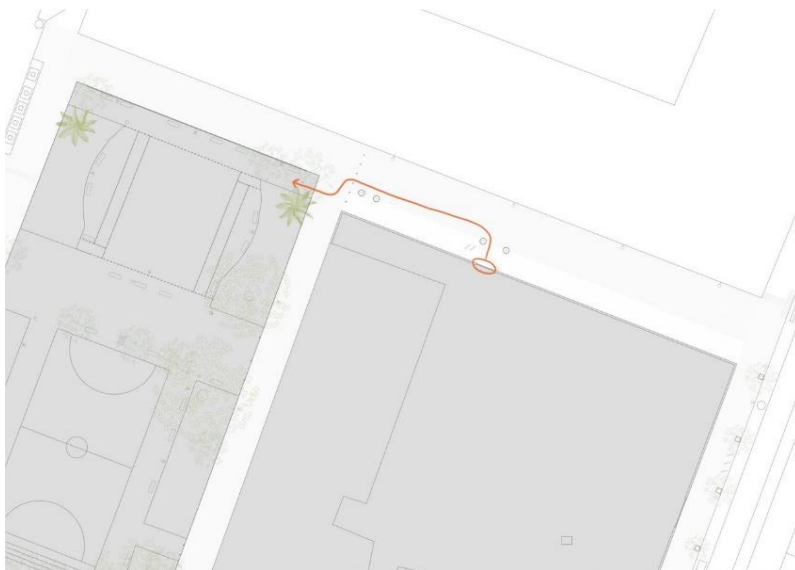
Recorrido puerta calle de Borriol.
